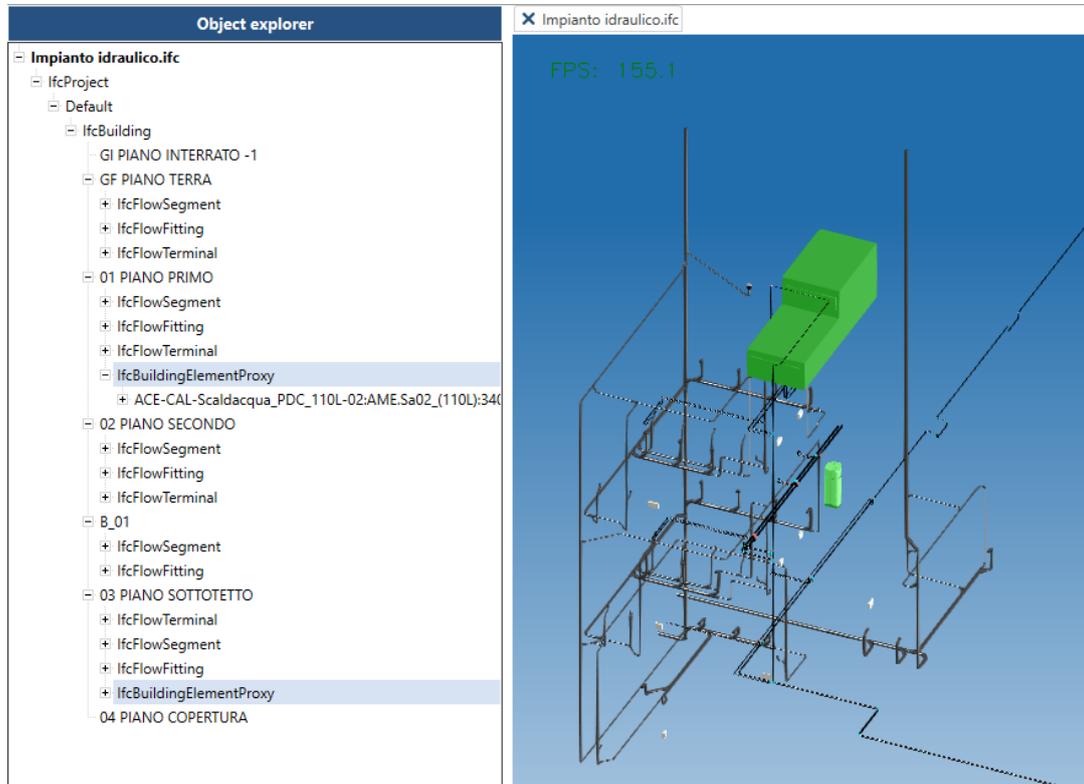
Visualizzazione in OpenIFC dell'impianto idraulico con individuazione degli IfcBuildingElementProxy
